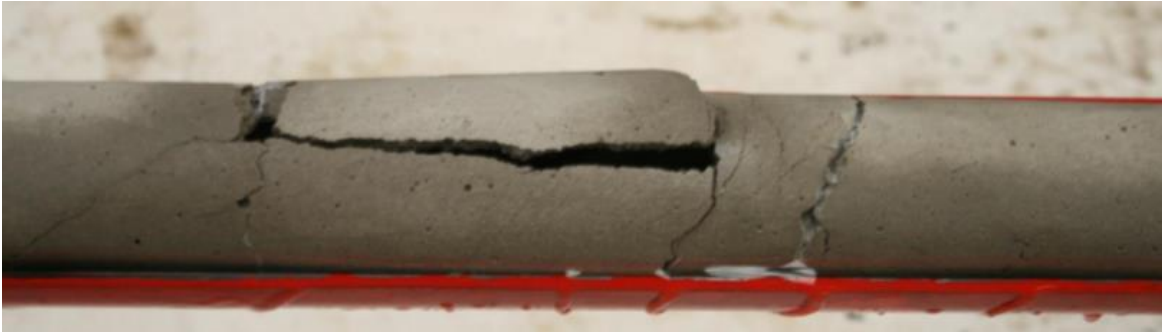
Ruptura y levantamiento de la clave de la tubería
